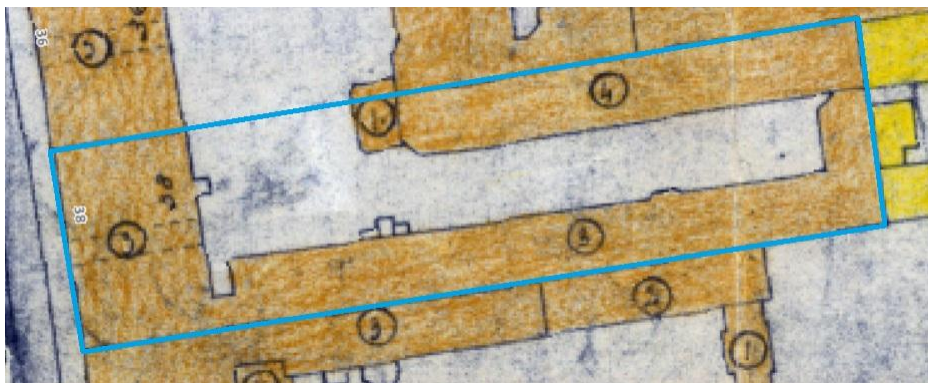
Dokumentacja archiwalna planu zabudowy posesji przy ul. Piotrkowskiej 38 z 1901 r. Źródło: Archiwa Towarzystwa Kredytowego w Łodzi, dostęp październik 2024, opracowanie własne.
